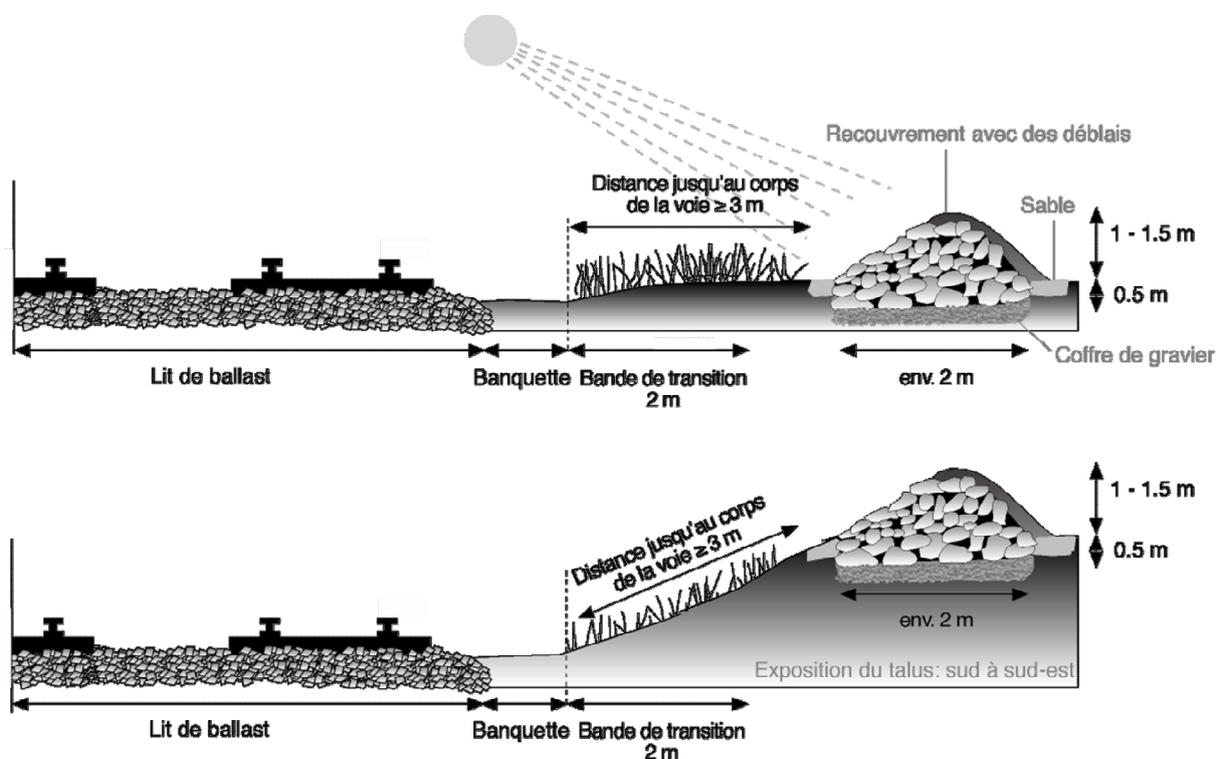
coupe transversale d'un tas de pierre. En haut: sur terrain plat; en bas: au sommet du talus.
